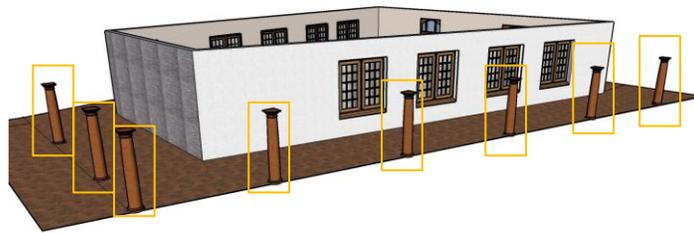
Columnas de madera que determinan un ambiente, Capilla
